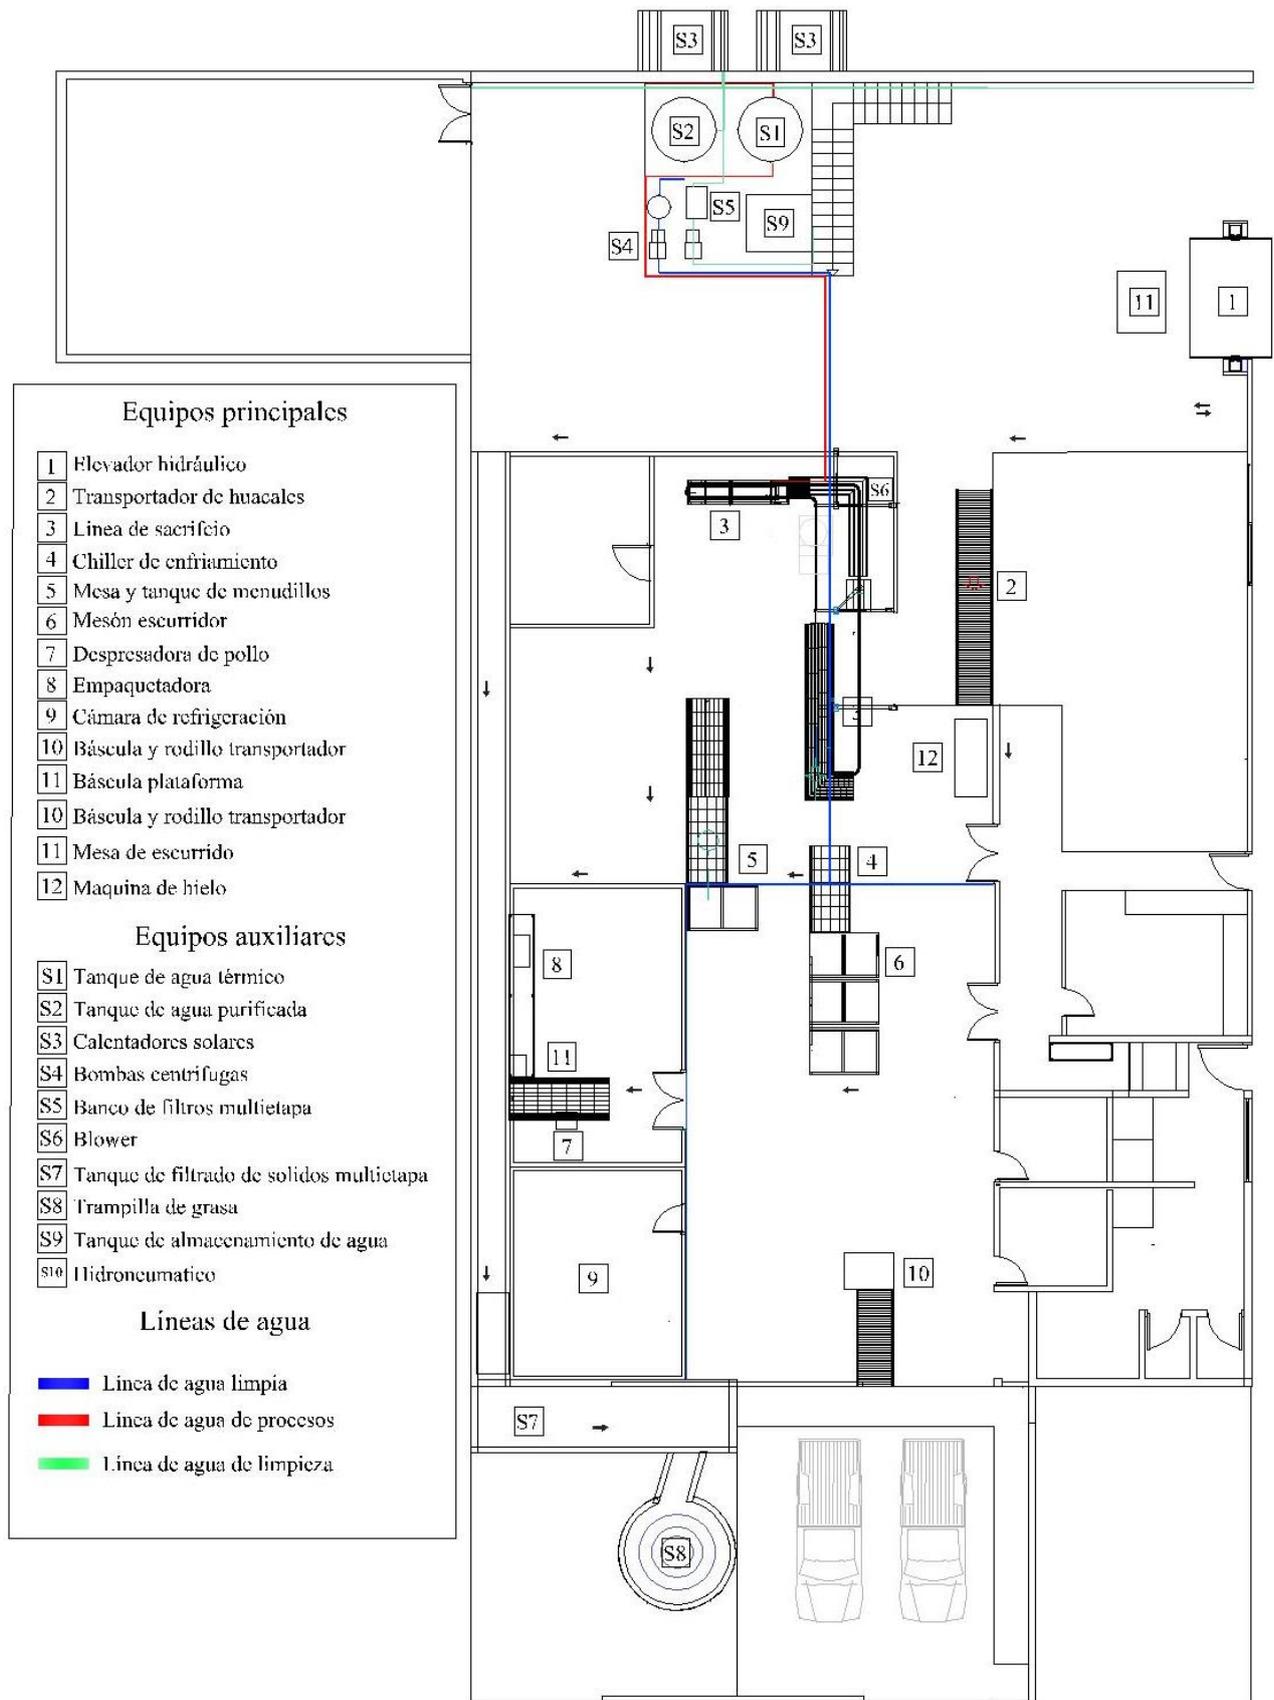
Distribución de equipos y sistemas auxiliares en la planta de beneficio propuesta.
